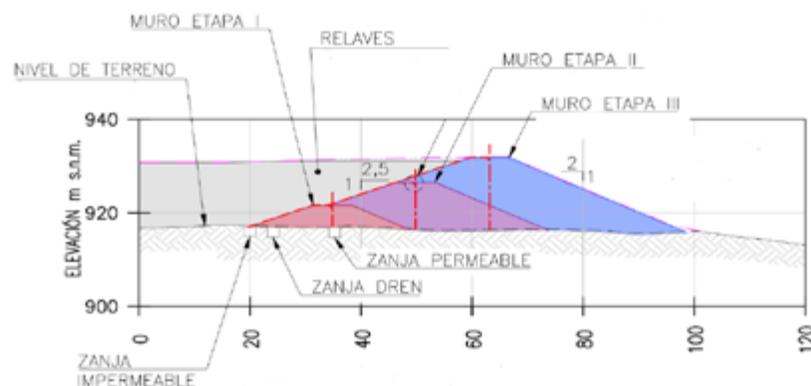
Sección Tipo Muro Depósito de Relaves Pampa Austral
